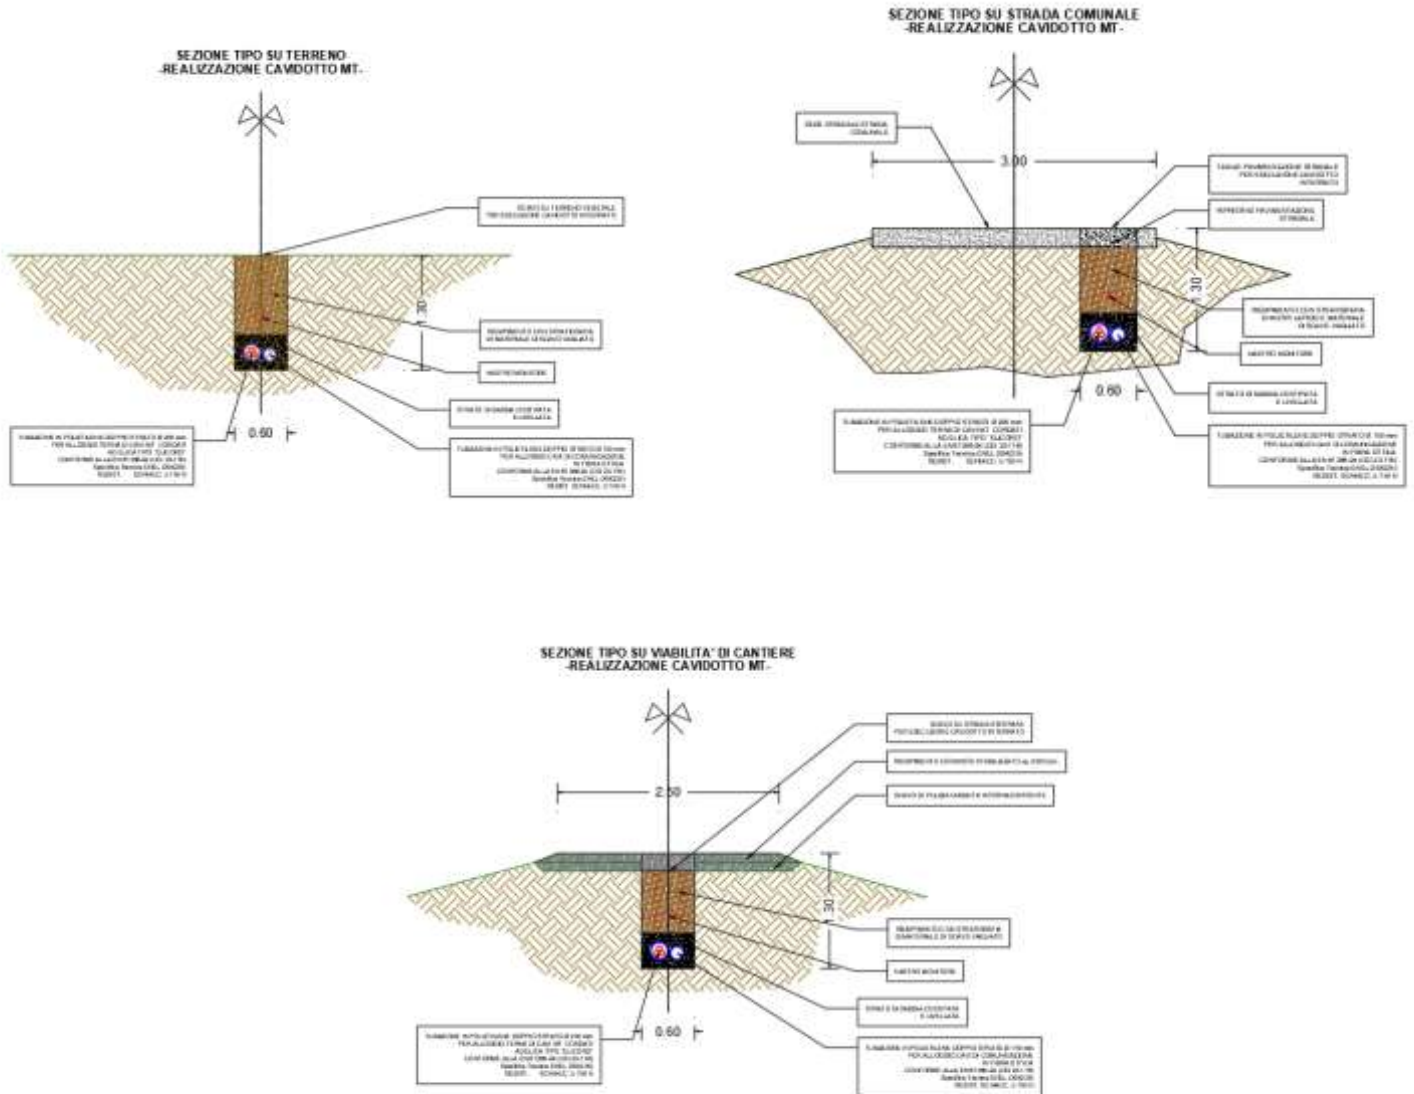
Particolare sezione tipo cavo interrato MT e particolari della sezione strada
